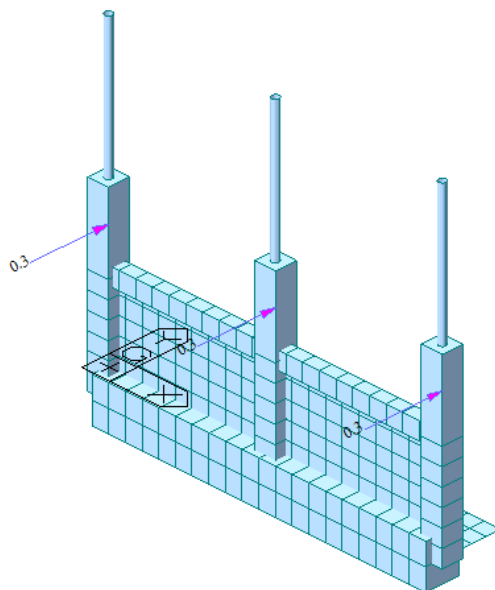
Carga de viento equivalente en pórticos de concreto armado. Fuente: MIDAS GEN.
